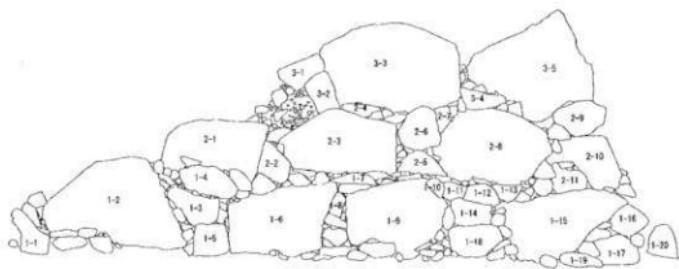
一の堀(南西部)石垣立面図(番付・墨打)
